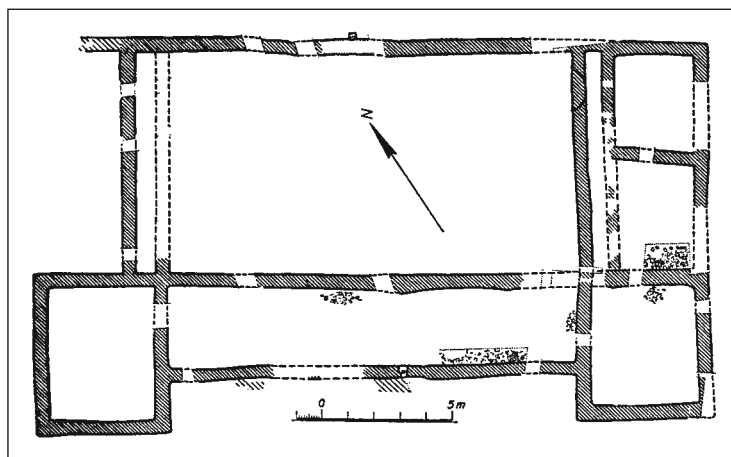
Grundriss einer kleinen *villa rustica* bei Neuss (nach H. v. Petrikovits, Novaesium (Köln-Graz 1957))
